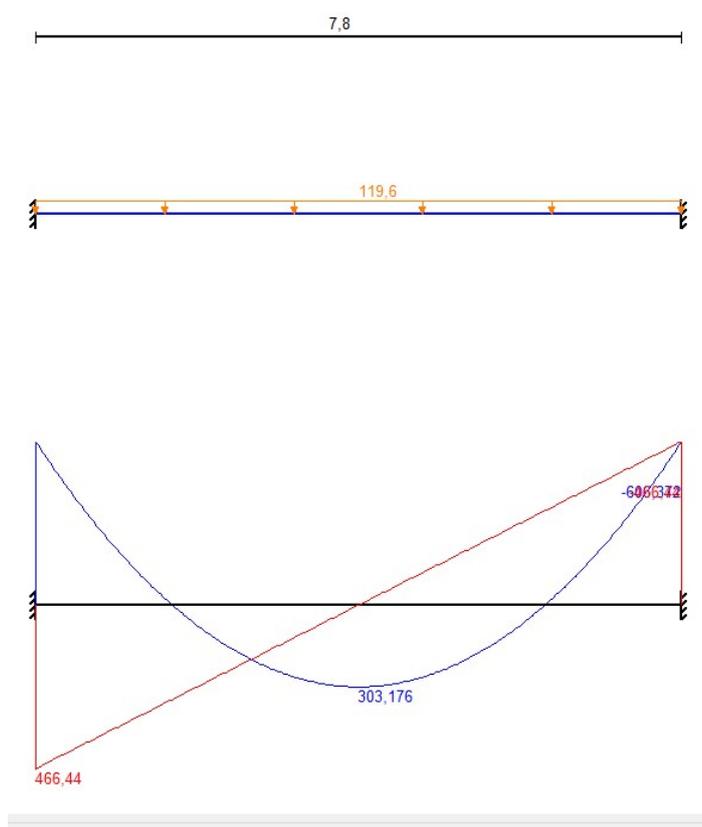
Схема приложения постоянной нагрузки на балку покрытия
